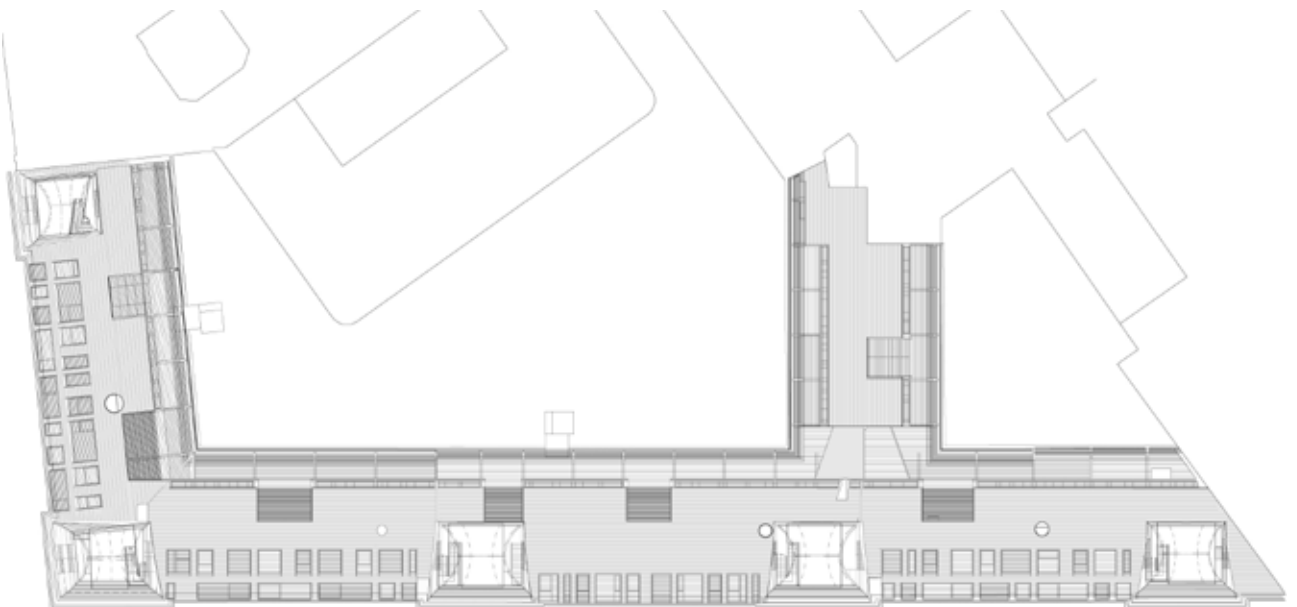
\_ Grundriss 3.DG © Boundary Silberfeil Architekten
